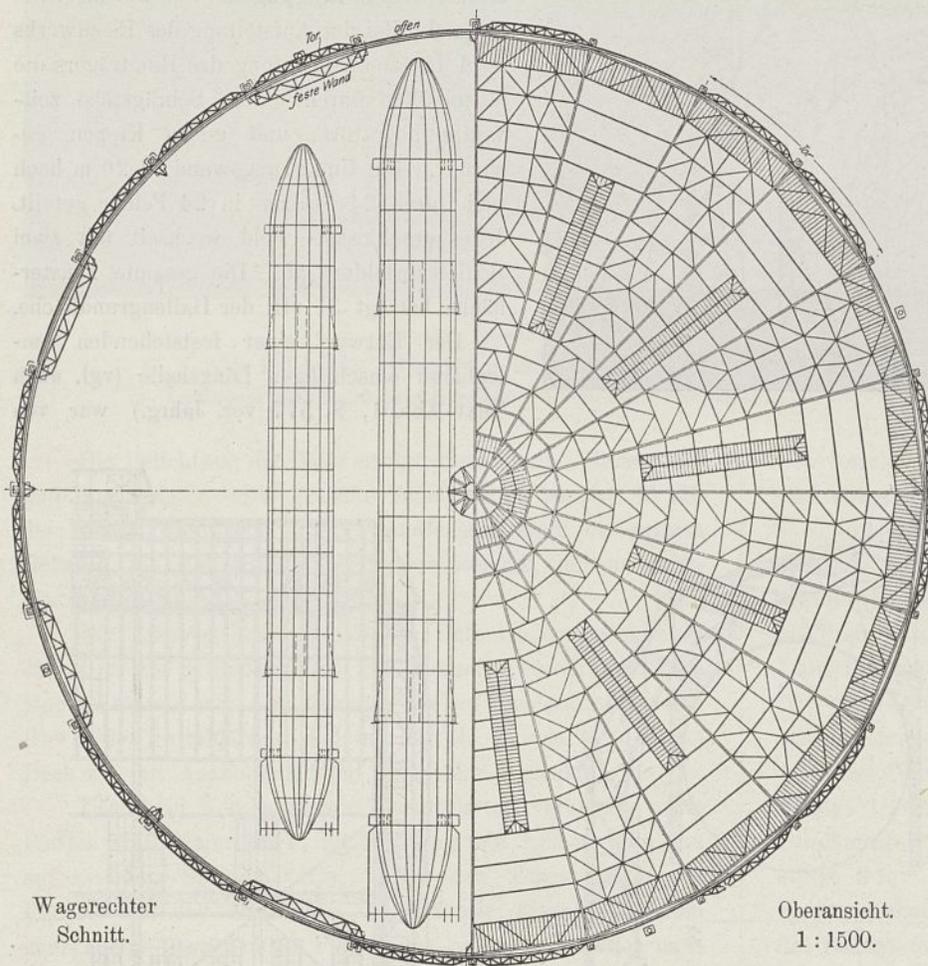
Mehrschiffige Rundhalle in Eisen.
